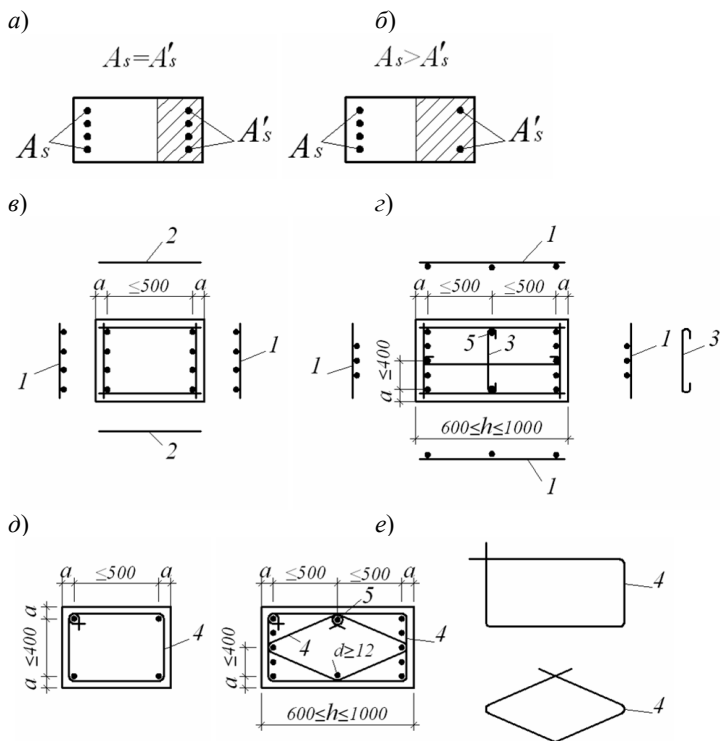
Армирование колонн с эксцентриситетом $e_0 > e_a$:
